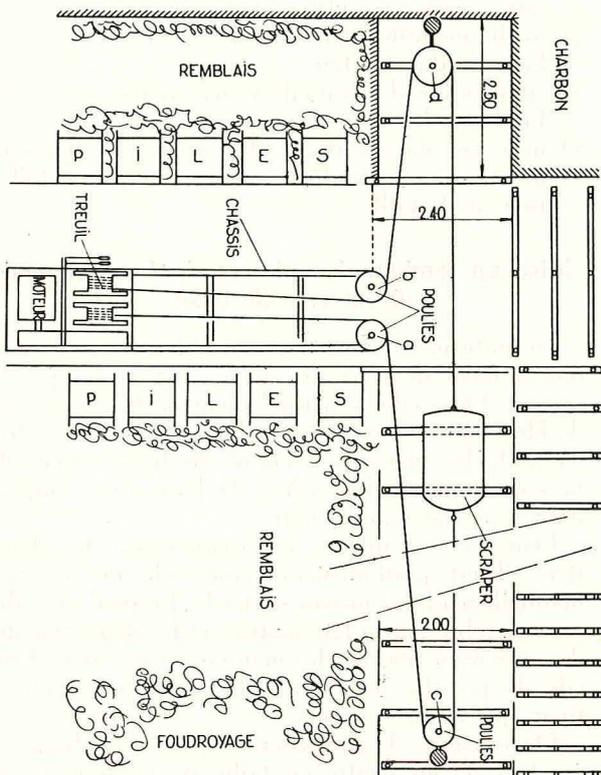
Installation pour mise au remblai des pierres de bossement des voies.
